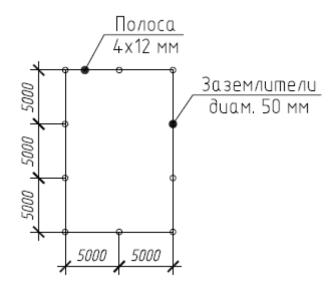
Конструкция заземляющего устройства (вид сверху)
